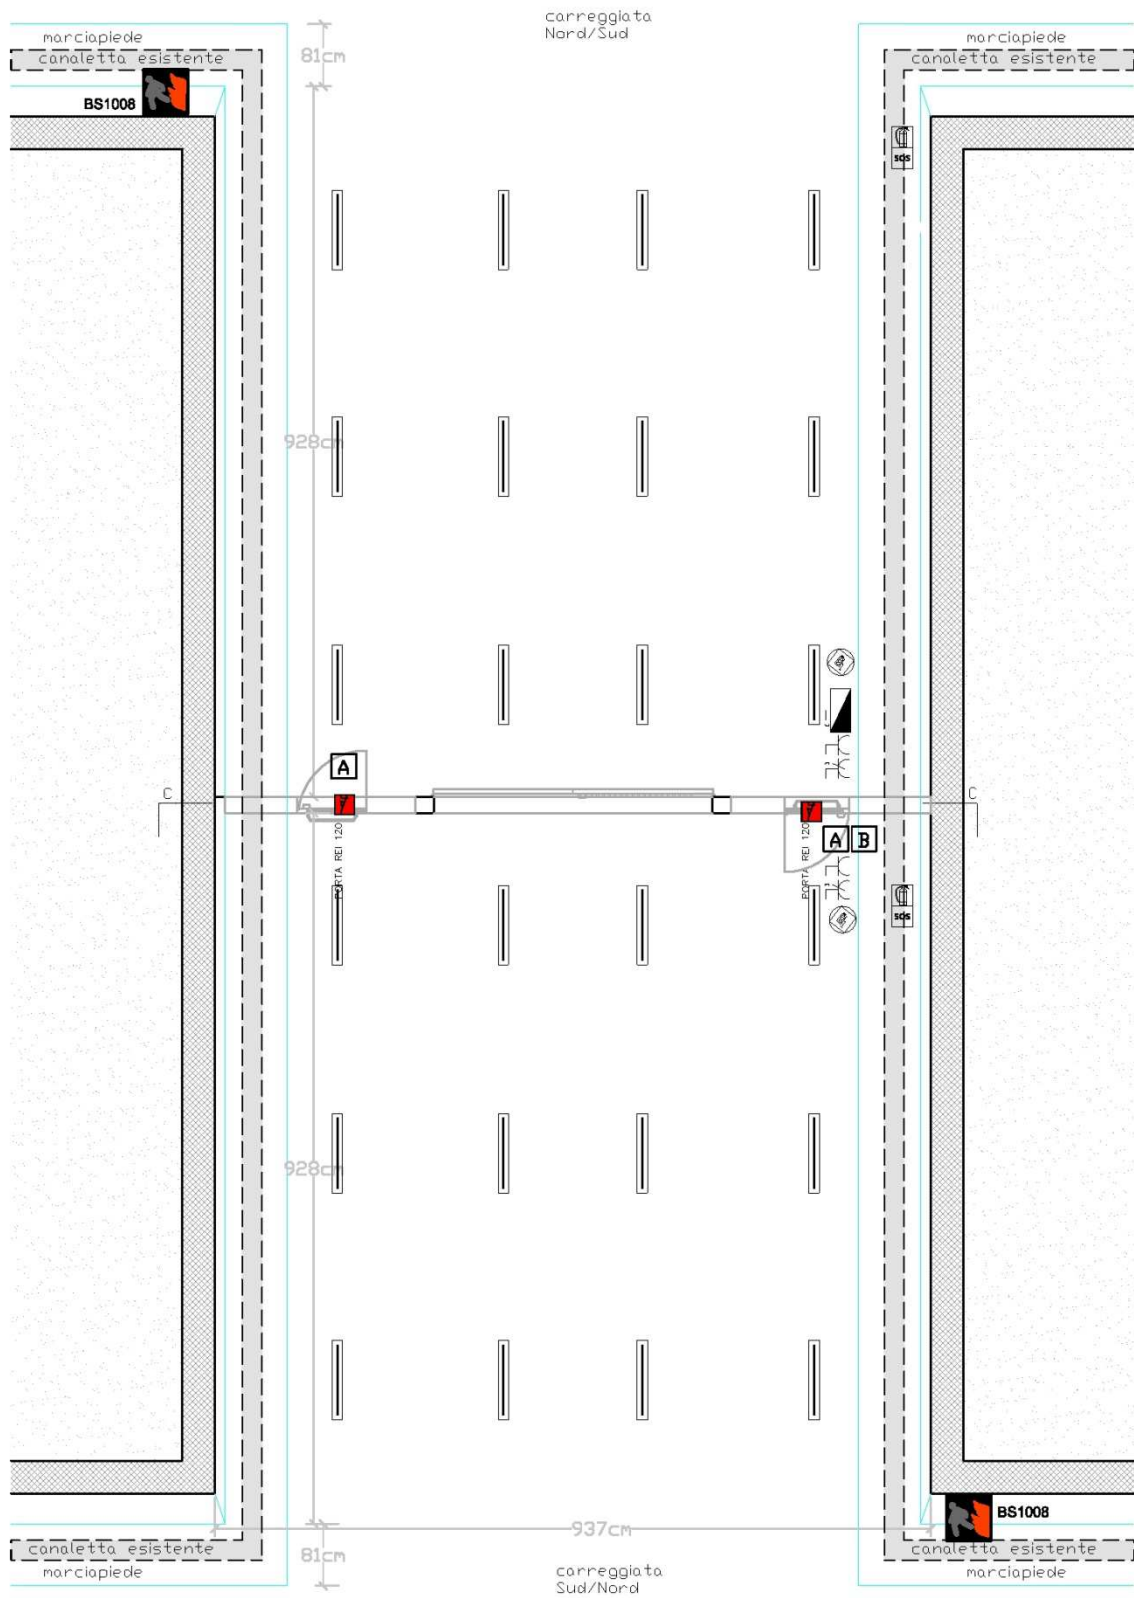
prima fase - piante e sezioni by-pass carrabile-pedonale
